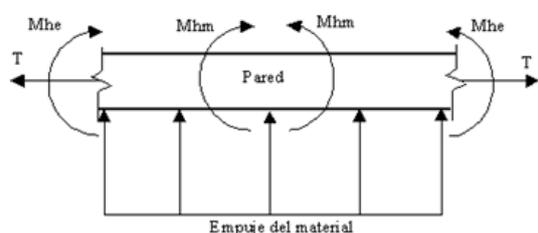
Sección en Planta de la Pared. Empuje del agua contenida en la CÁMARA
